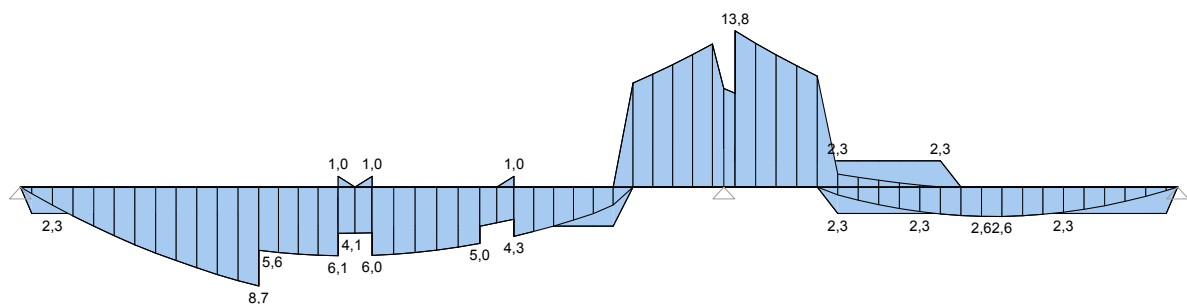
Erf. Längsbewehrung (inkl. äußerer Lagen der Öffnungsurte). Maßstab 1 : 66,7, 1cm = 6,67cm².
